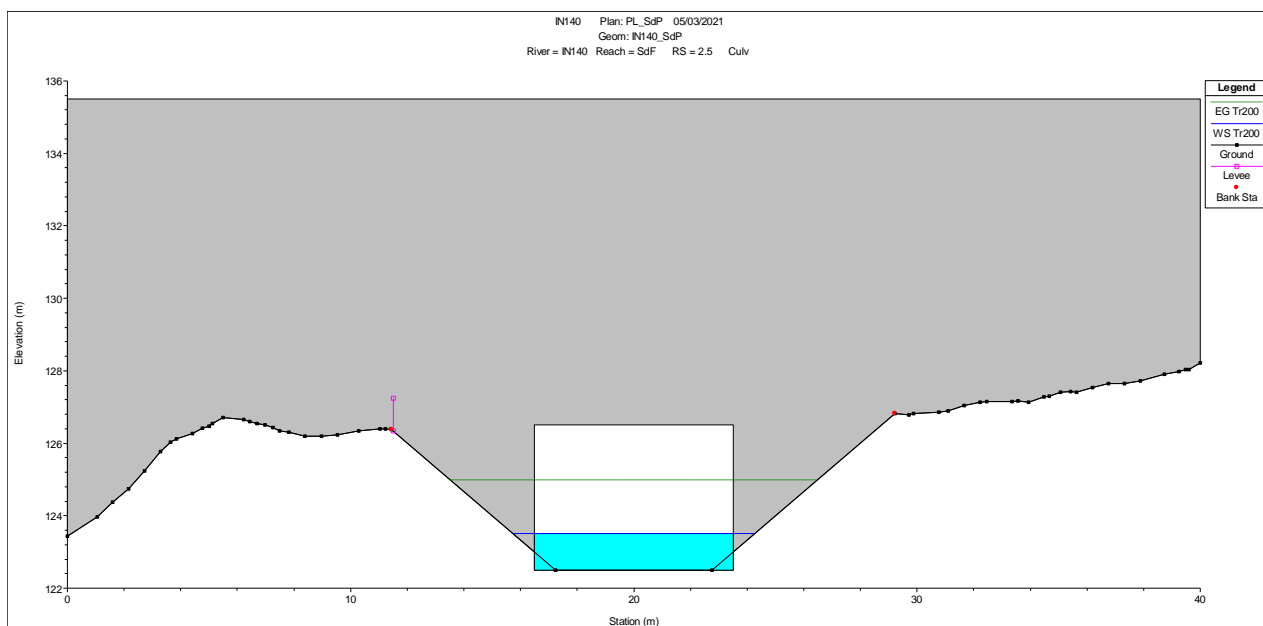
Sezione valle manufatto – stato di progetto interferenza IN140.
